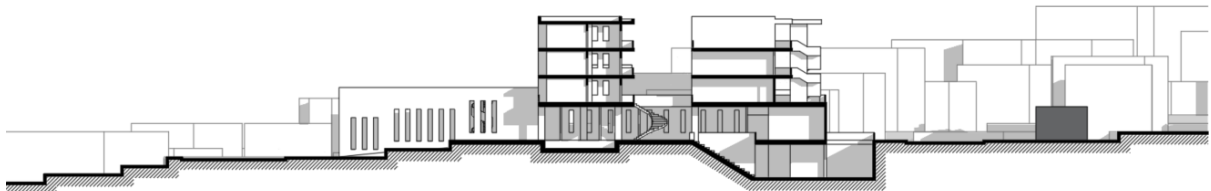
Sección A-A' - Anteproyecto 02. Elaboración propia.
